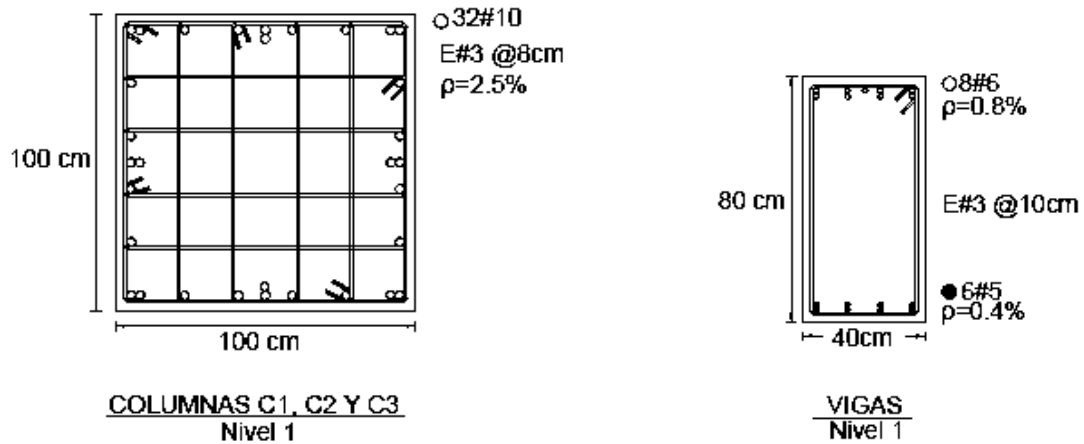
Armado de vigas y columnas diseñadas con las NTCC-17 para el edificio de 4 niveles cuyo sistema estructural consiste en marcos dúctiles y muros diafragma de mampostería
